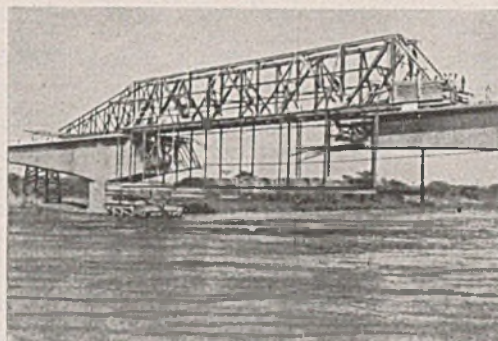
Vorbelastung der im Freivorbau erstellten 32 m langen Konsole (rechts) des 70 m-Überbaues durch das Gewicht der Betonierbrücke.
